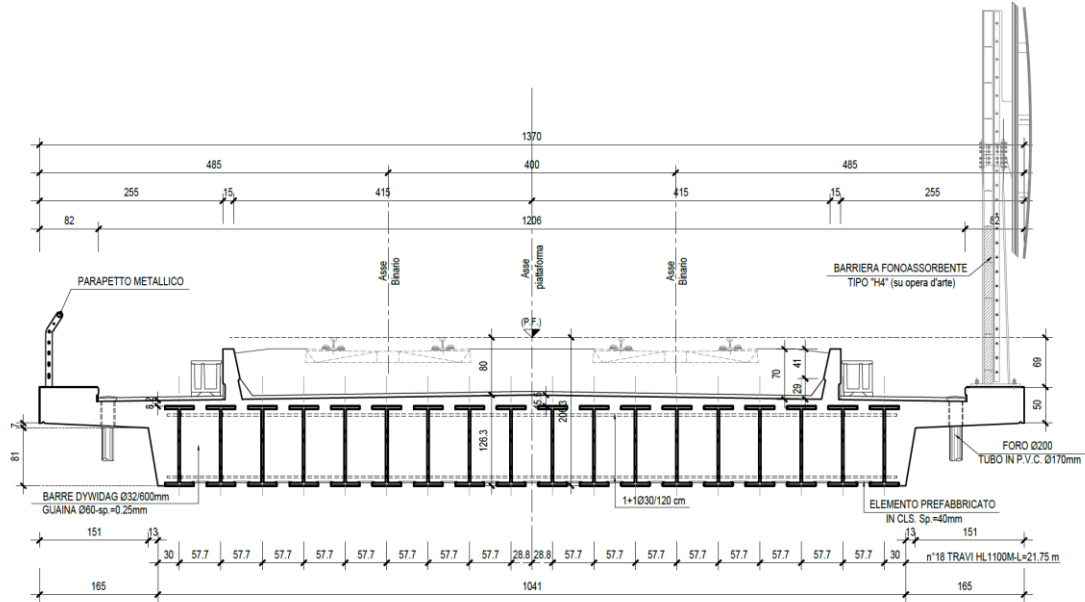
Sezione trasversale corrente – impalcato L=22m
